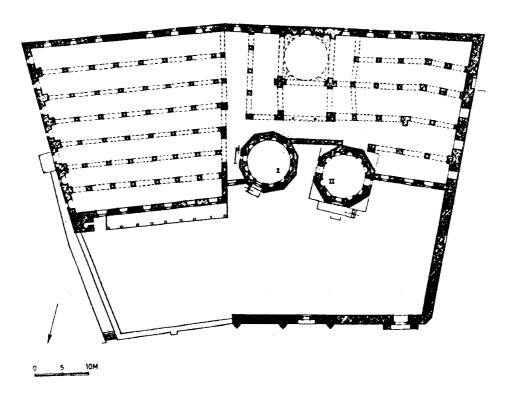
مسقط أفقي للجامع الكبير (اولو جامع) في سيواس (عن : Aslanapa).
